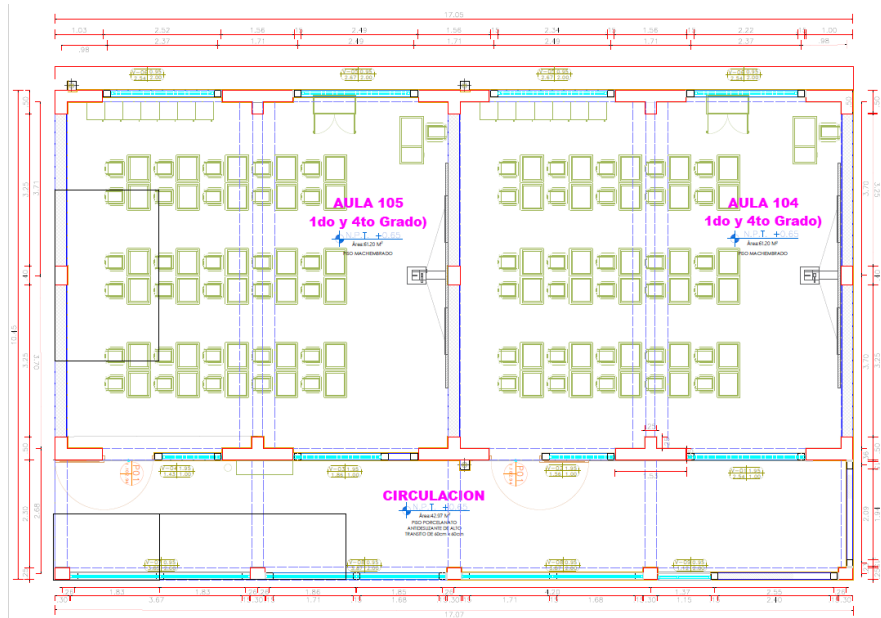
Planta típica del diseño de arquitectura del bloque A de la IEP 70001
